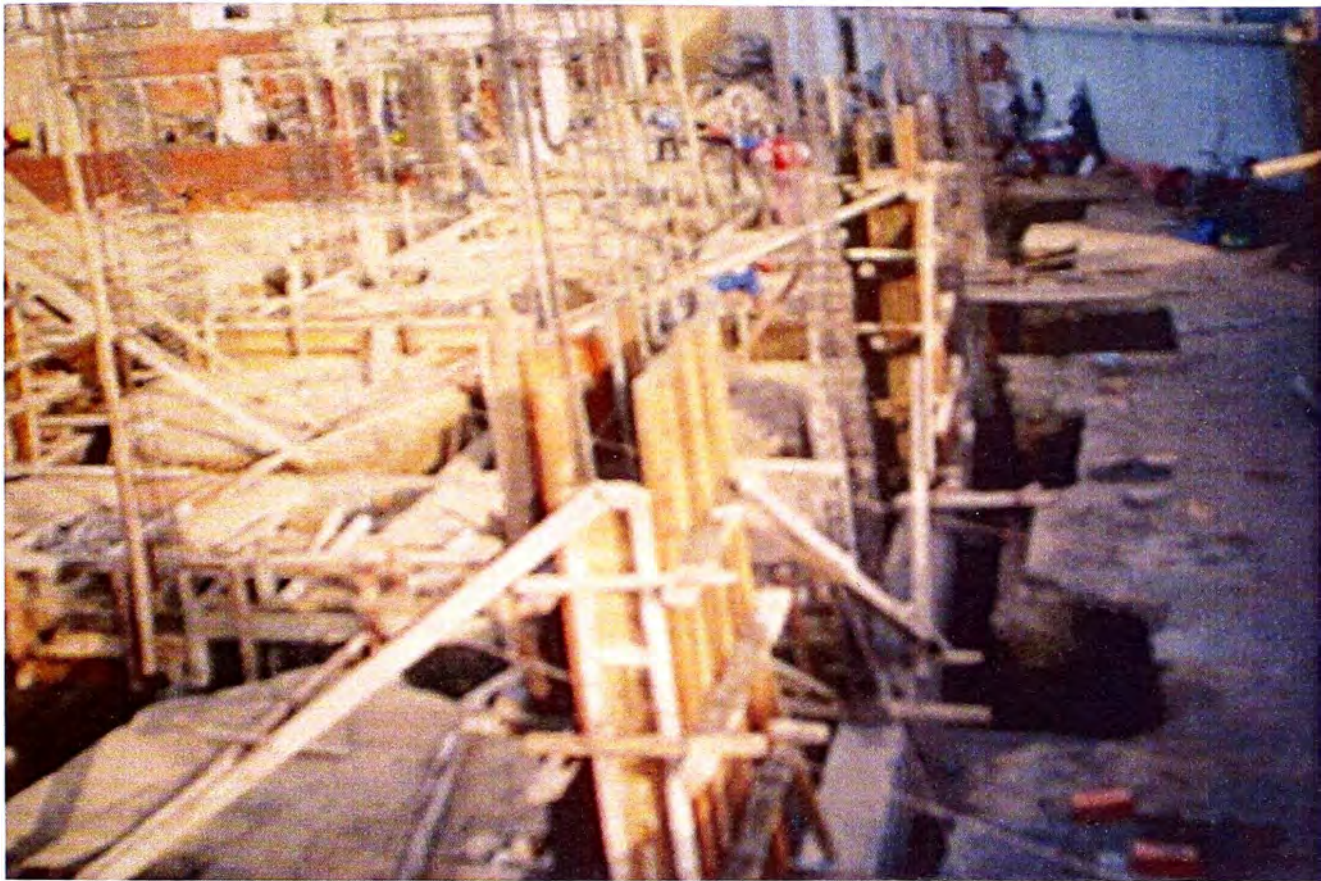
VISTA DE ENCOFRADO DE PLACAS Y SOBRECIMENTOS Y DEMAS
